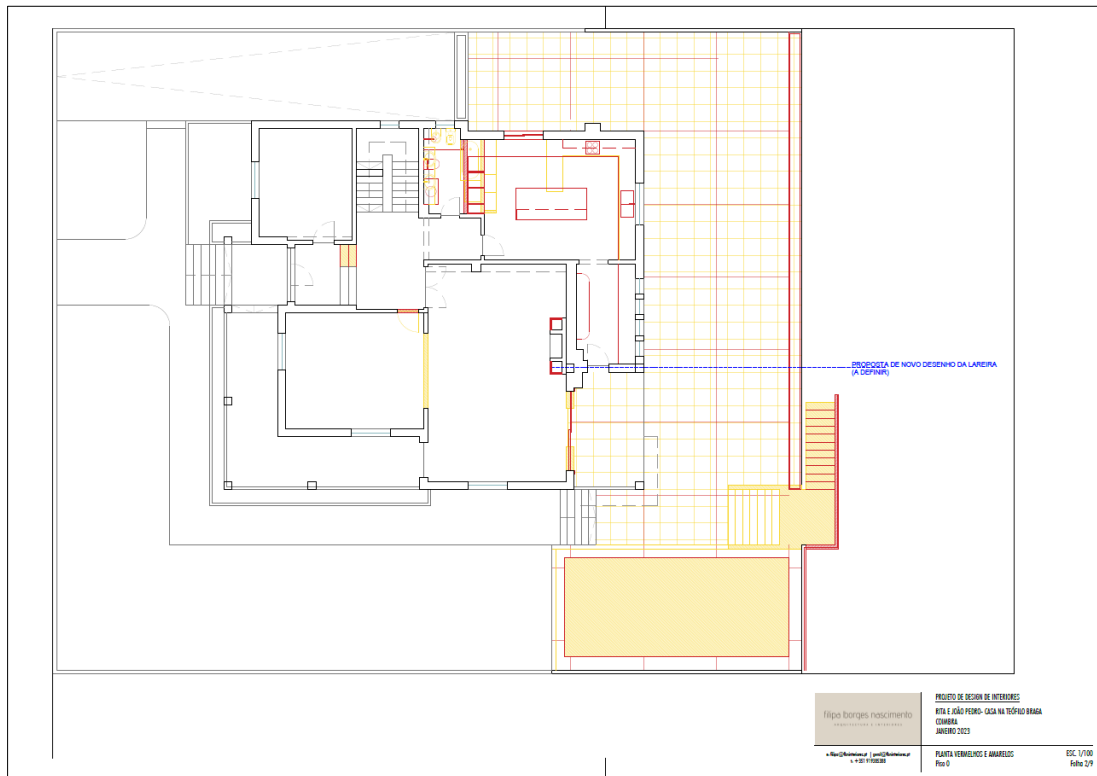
Planta vermelhos e amarelos (Fonte: Autora, 2022)
